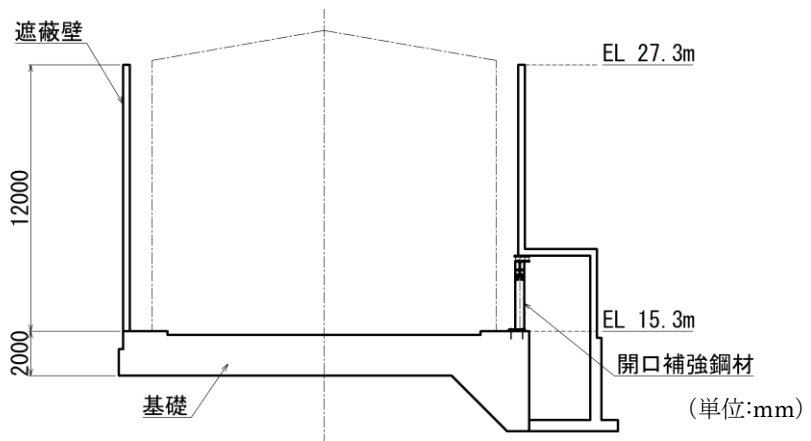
トーラス水受入タンク遮蔽壁 断面図 (A-A 断面, 東西)
